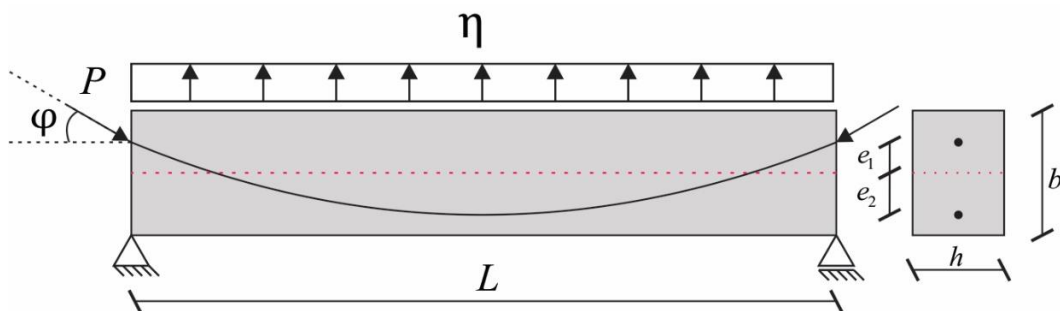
Geometria da cordoalha e seção transversal da viga.
